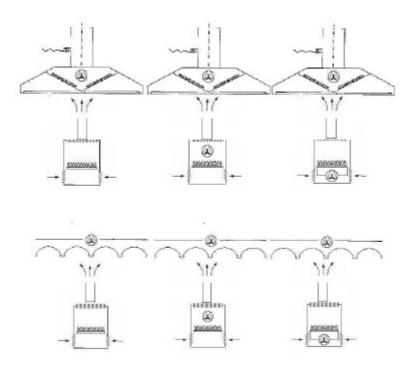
Installazione di apparecchi di tipo A1/ A2/con condotto singolo, sotto un sistema di aspirazione con ventilazione forzata
